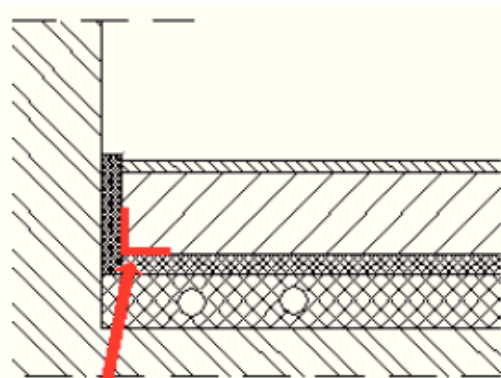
esempio di posa corretta del nastro resiliante di giunzione tra materiale a pavimento e fascia perimetrale
